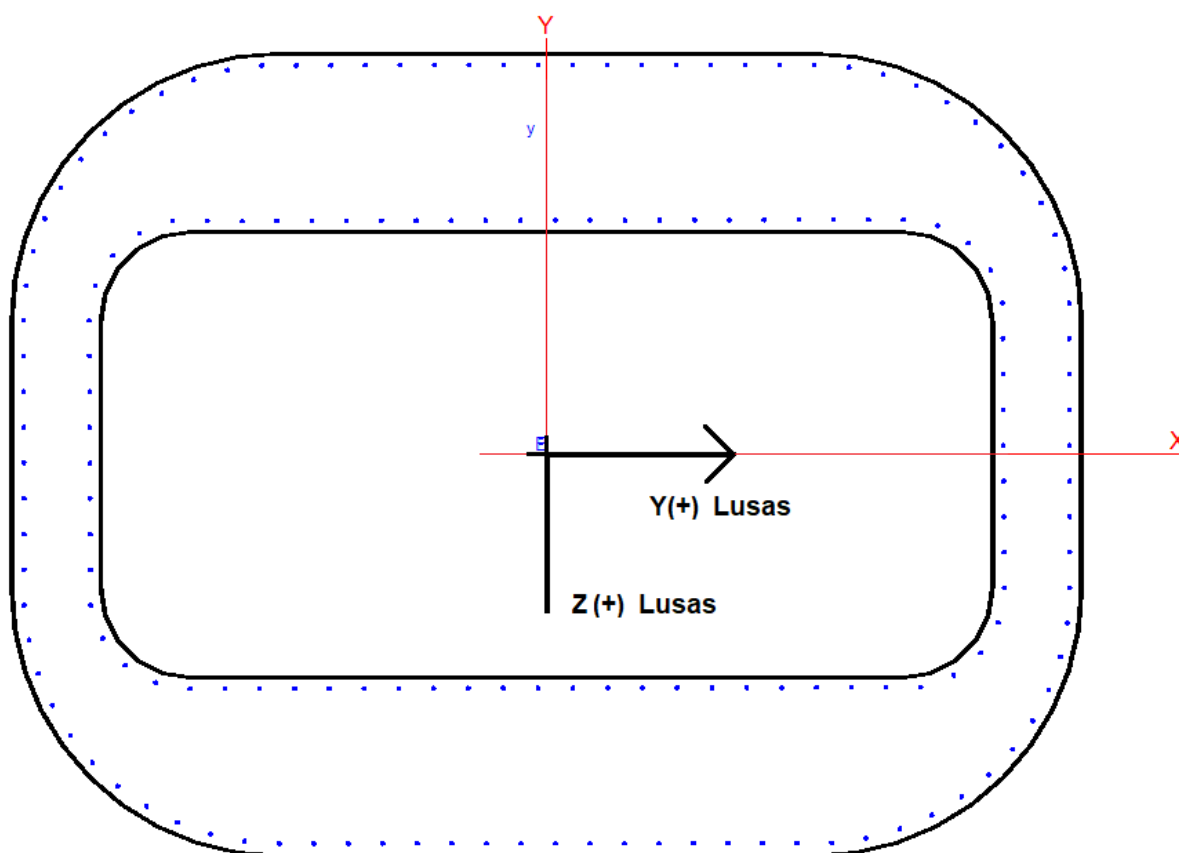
Sezione Pila-Spalla - Sistema di riferimento RC-sec / LUSAS
